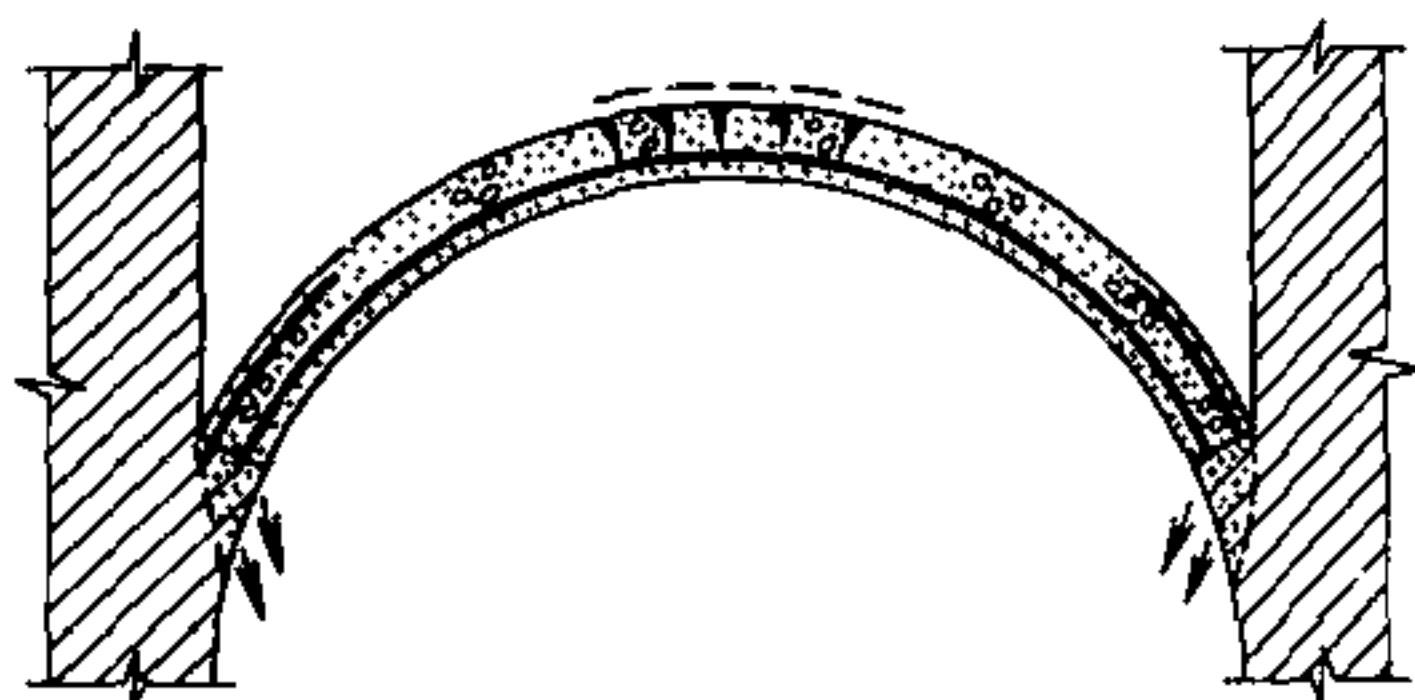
Трещины в своде (с дополнительной арматурой), смятие и выпадение камней в пятах свода, коррозия и выкрашивание бетона в верхней части свода
